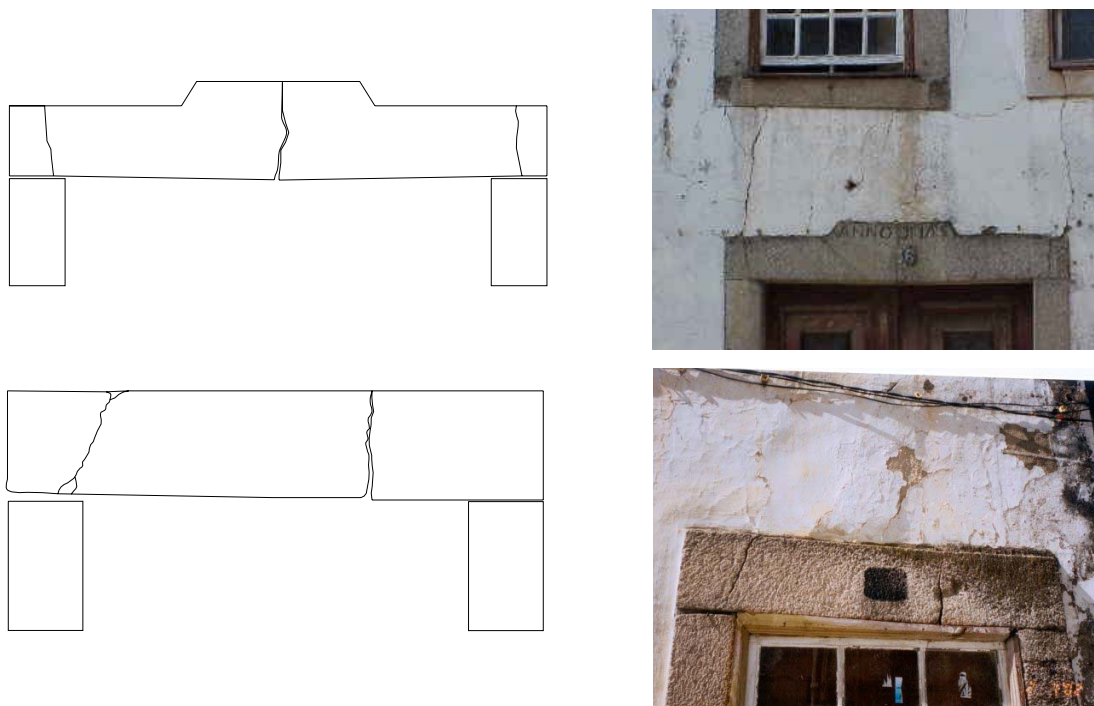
Fissuração de algumas padieiras de pedra
